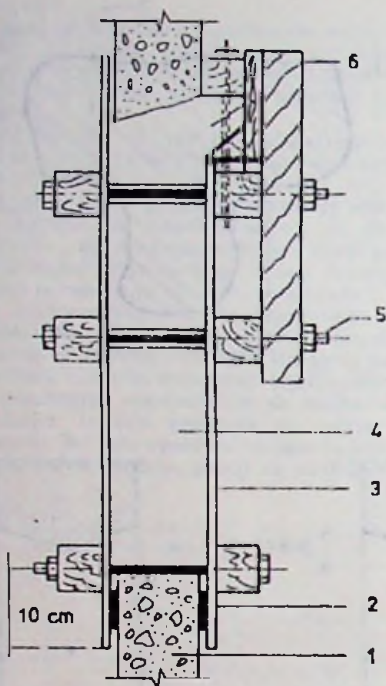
Cofraj pentru rebetonarea unei zone avariate într-un element de beton simplu (după document ONU [1]): 1 — beton existent; 2 — bandă de plăci prinsă în cofraj; 3 — cofraj; 4 — beton nou; 5 — tensor de distanță; 6 — fantă de turnare și capac pentru producerea presiunii.
